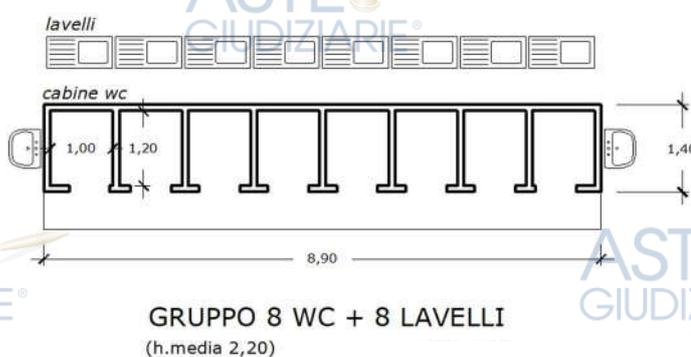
Il blocco servizi composto da 8 cabine wc e retrostante area lavelli (rif.n.2 nella planimetria catastale agli atti - riff.n.6 e n.7 nella planimetria di progetto a pag.22)
